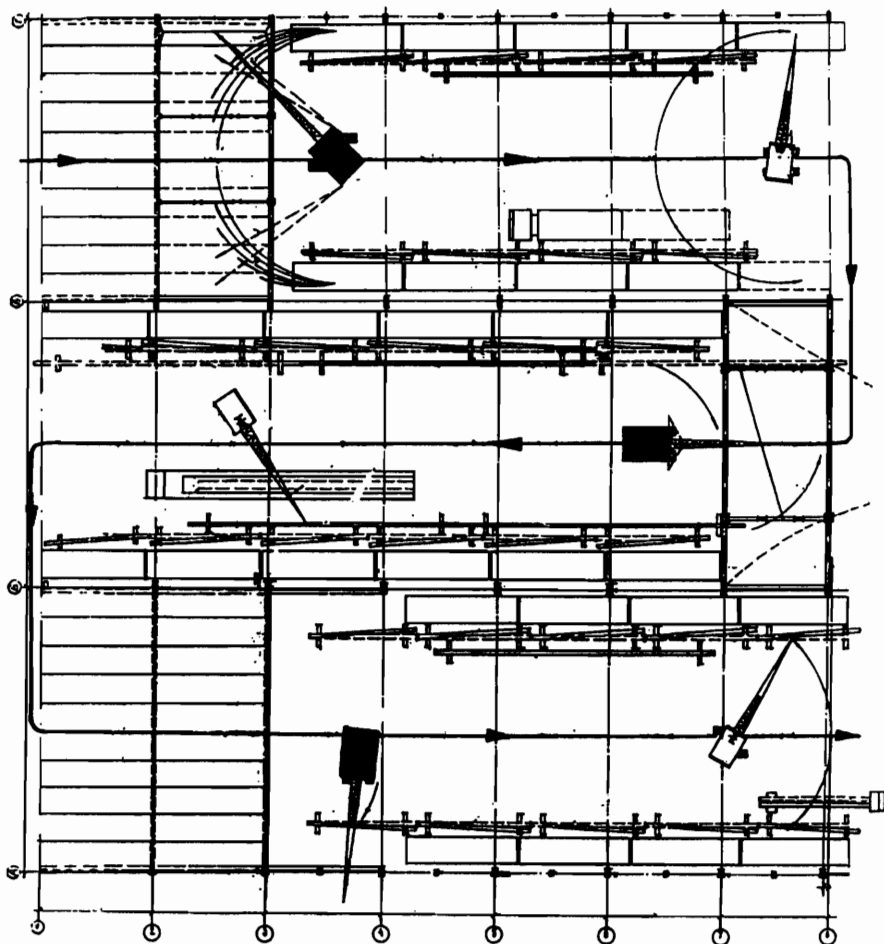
План монтажных участков трехпролетного одноэтажного промздания
